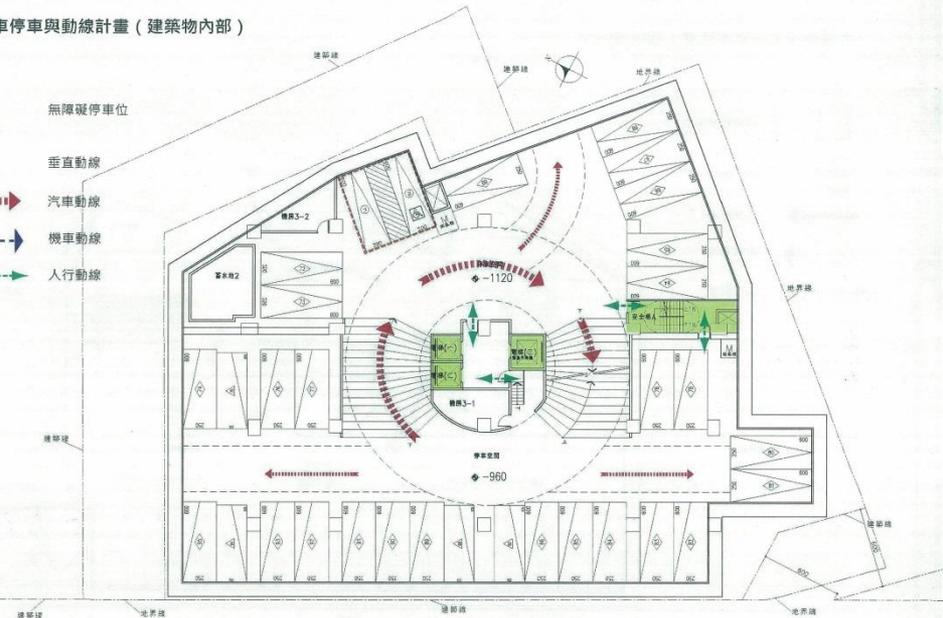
車行及人行動線計畫 (內部): 地下 1 層 S:1/200
